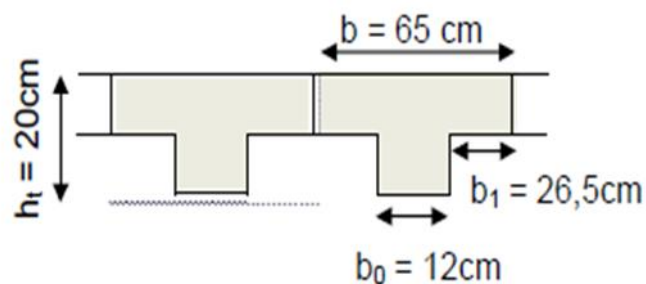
Section de la poutrelle après coulage de la dalle de compression
